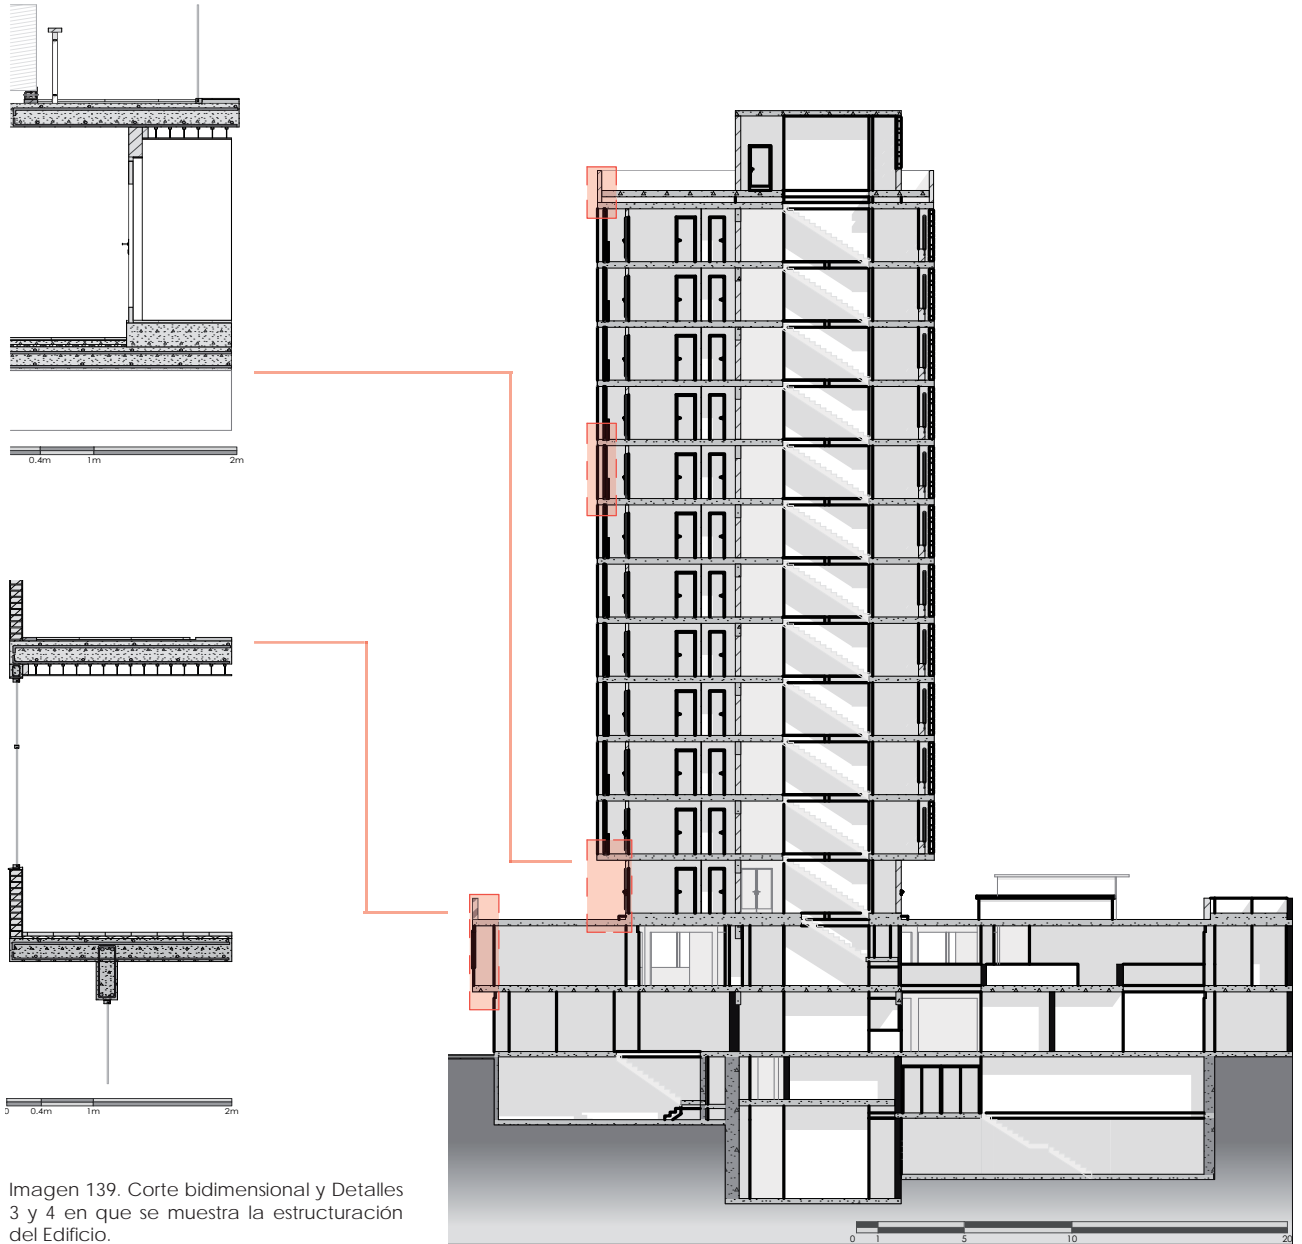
Corte bidimensional y Detalles 3 y 4 en que se muestra la estructuración del Edificio.
